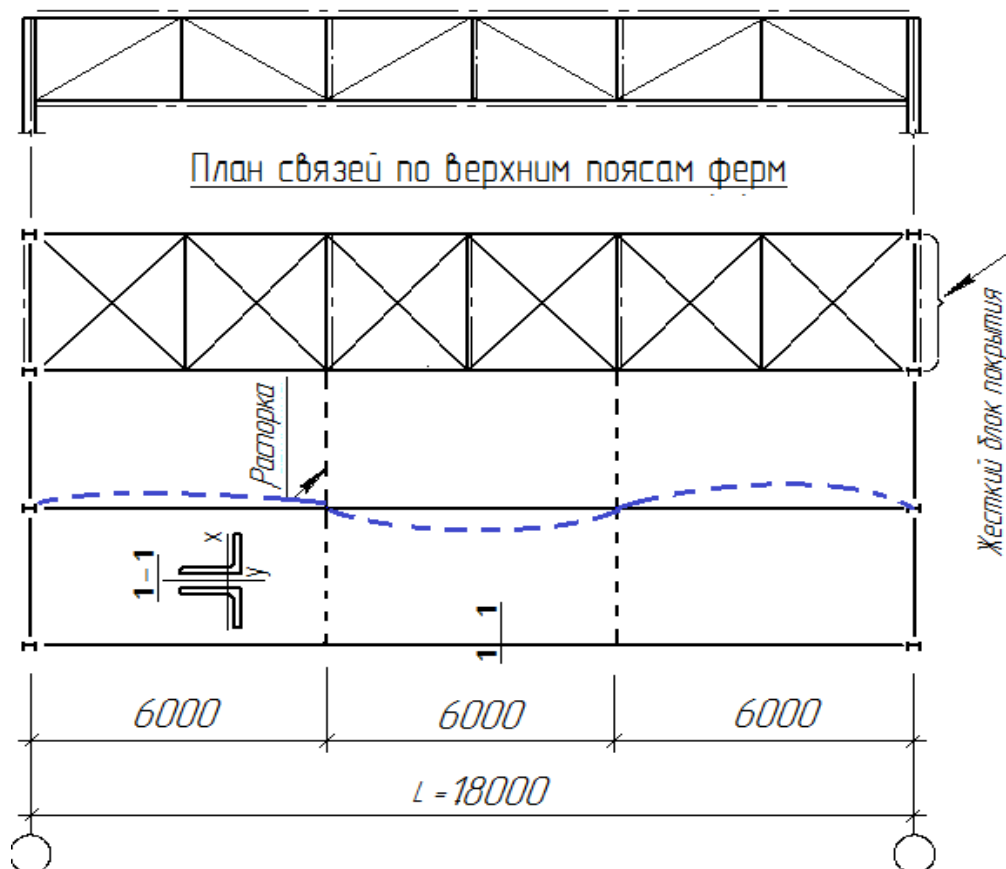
К вопросу определения количества распорок по верхним поясам стропильной фермы
